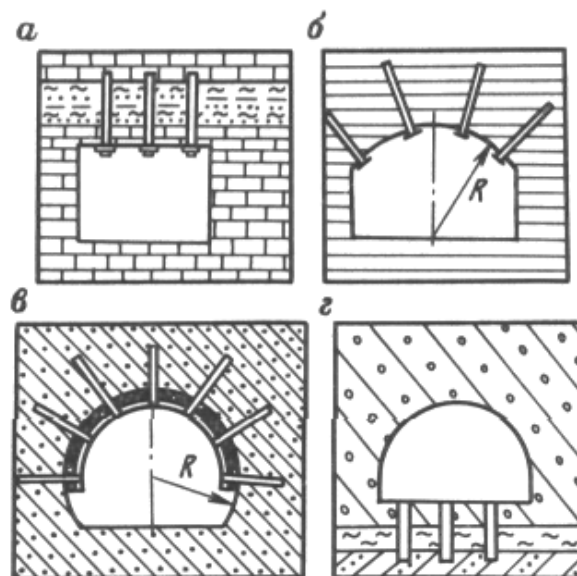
Схемы крепления выработок штангами: а, б – с опорными плитками; в – с арочными стальными подокнами; г – крепление со стороны почвы
